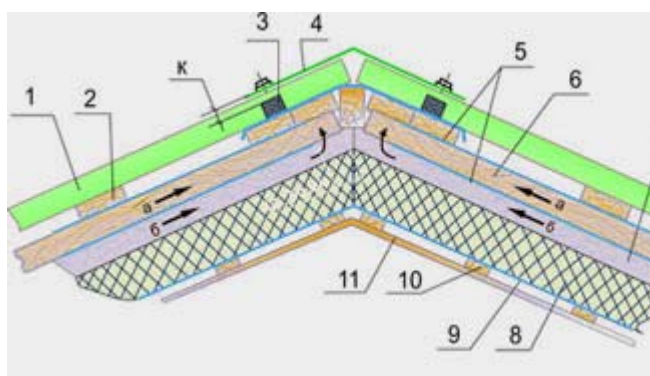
Утеплённая кровля: 1 — профнастил (металлочерепица); 2 — обрешётка; 3 — уплотнитель коньковый; 4 — конёк; 5 — гидроизоляционная паропроницающая пленка; 6 — стропильная планка (брус контробрешетки); 7 — стропильная нога; 8 — утеплитель; 9 — паронепроницающая плёнка; 10 — потолочная рейка; 11 — гипсокартон, вагонка; а — продкровельная вентиляция; б — вентиляция между утеплителем и гидроизоляционной пленкой
